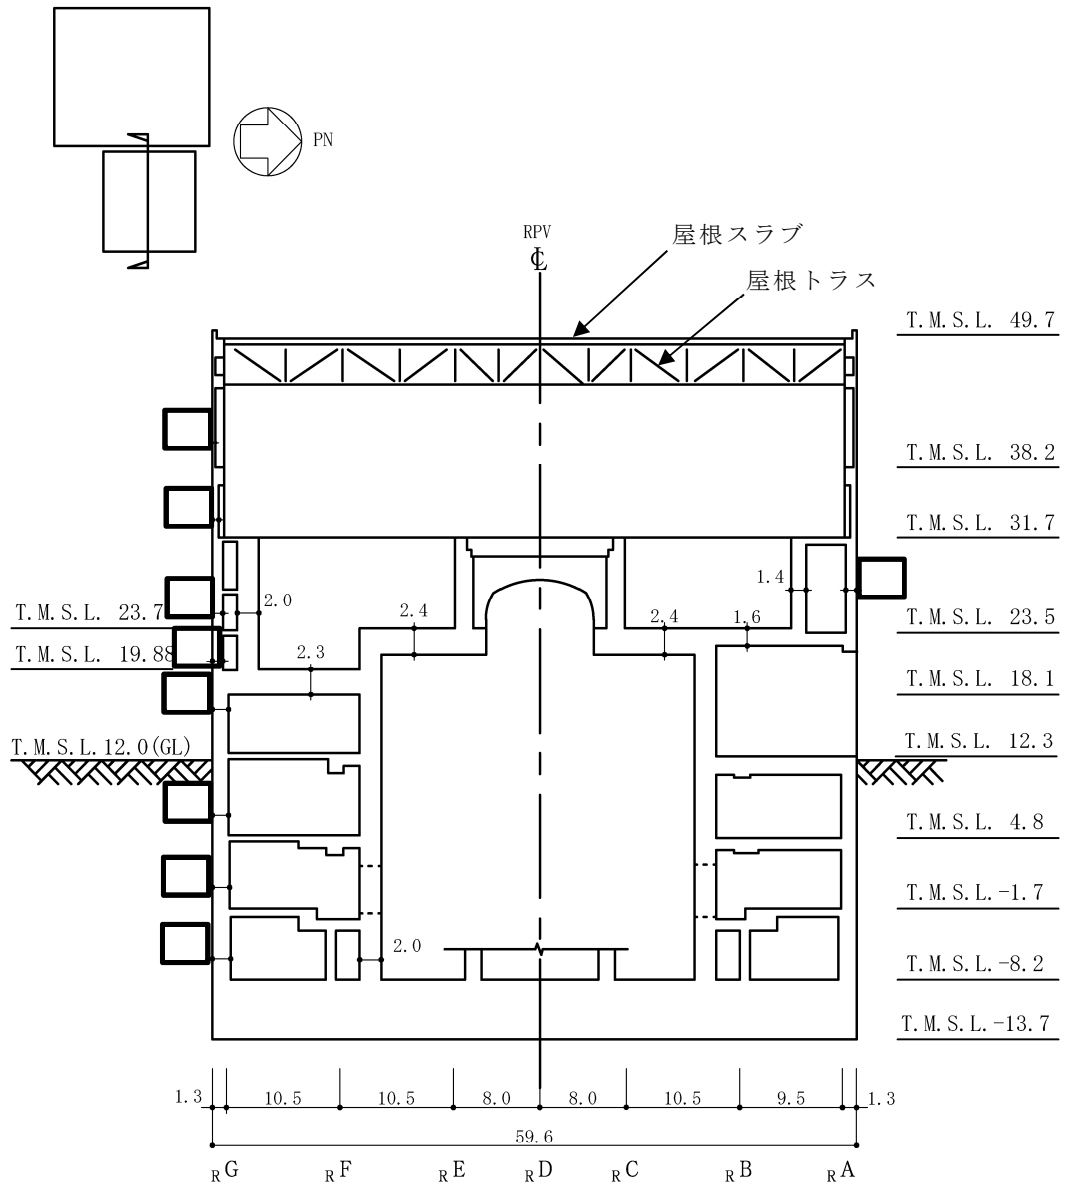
原子炉建屋の概略断面図 (EW方向) (2/2) (単位 : m)
